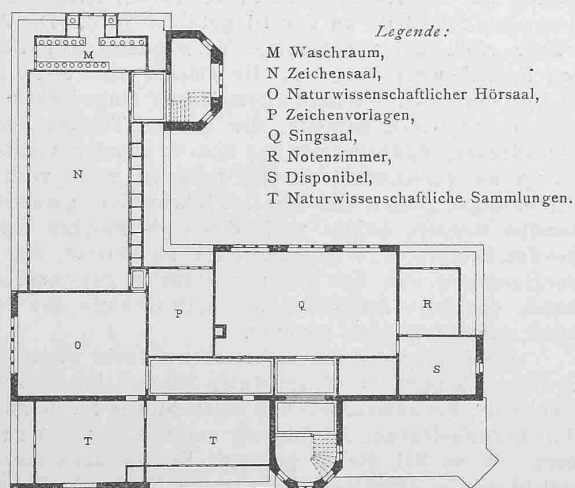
Grundriss vom Dachgeschoss. — 1:500.
